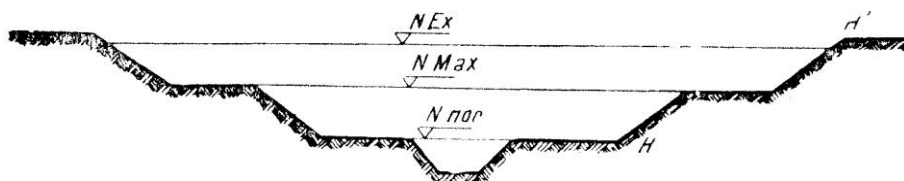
Secțiune transversală – de formă trapezoidală, cu cunetă și banchete – printr-un canal principal de evacuare.
